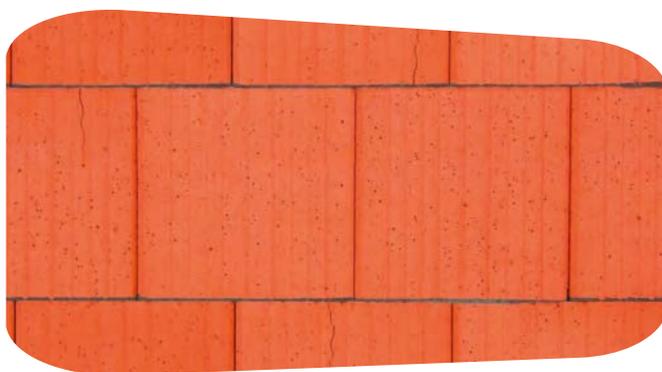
Ziegelmauerwerk mit Trocknungs- oder Brennrisse
